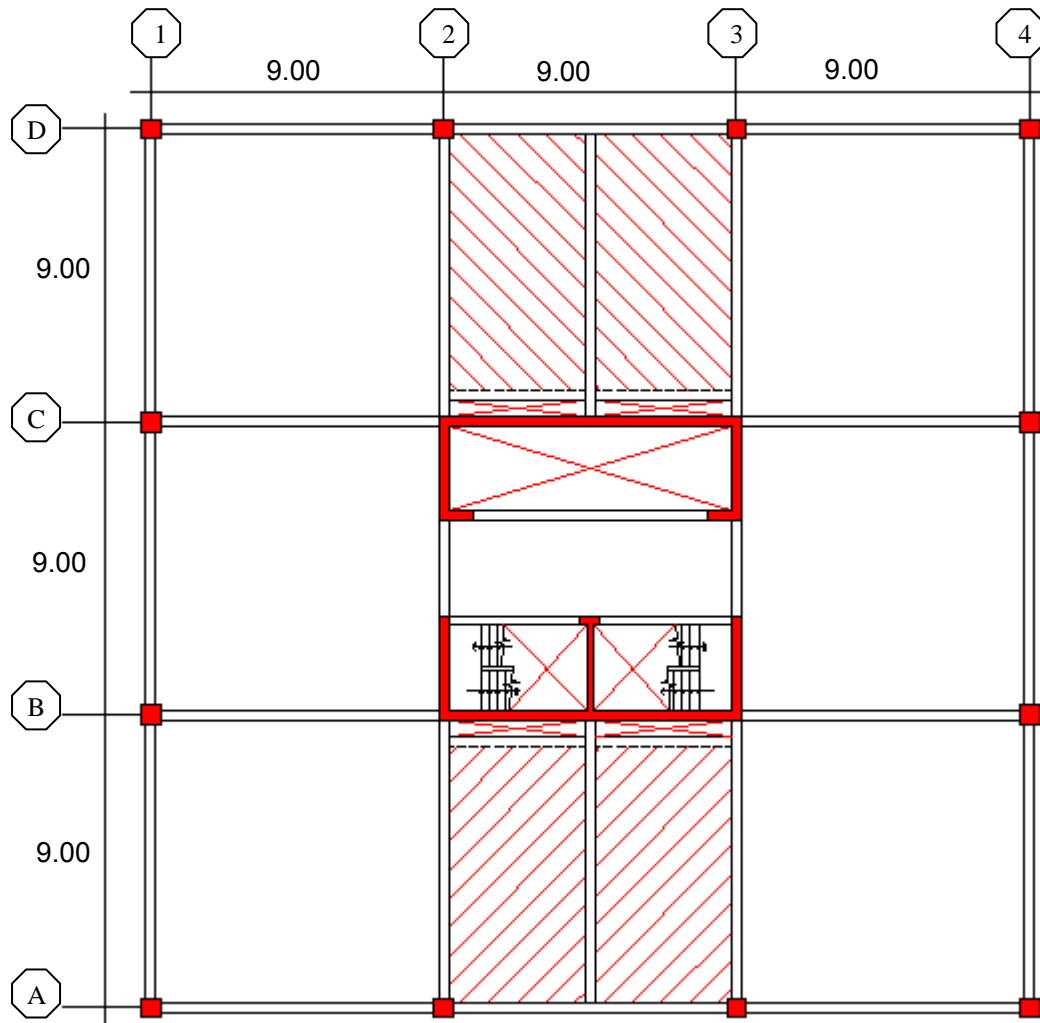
Planta estructural típica del segundo al noveno piso sin vigas intermedias.
